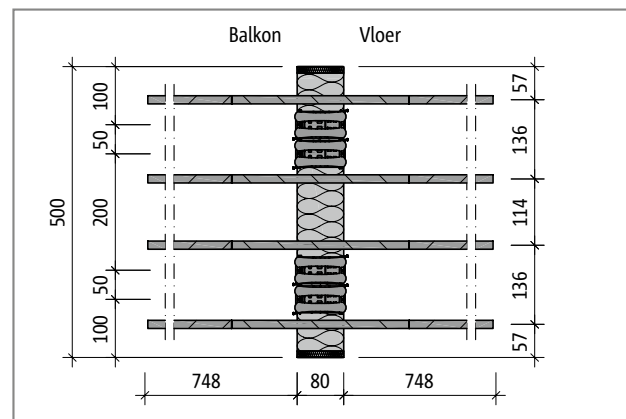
Schöck Isokorb® T type Q-E-V5-L250: Bovenaanzicht
